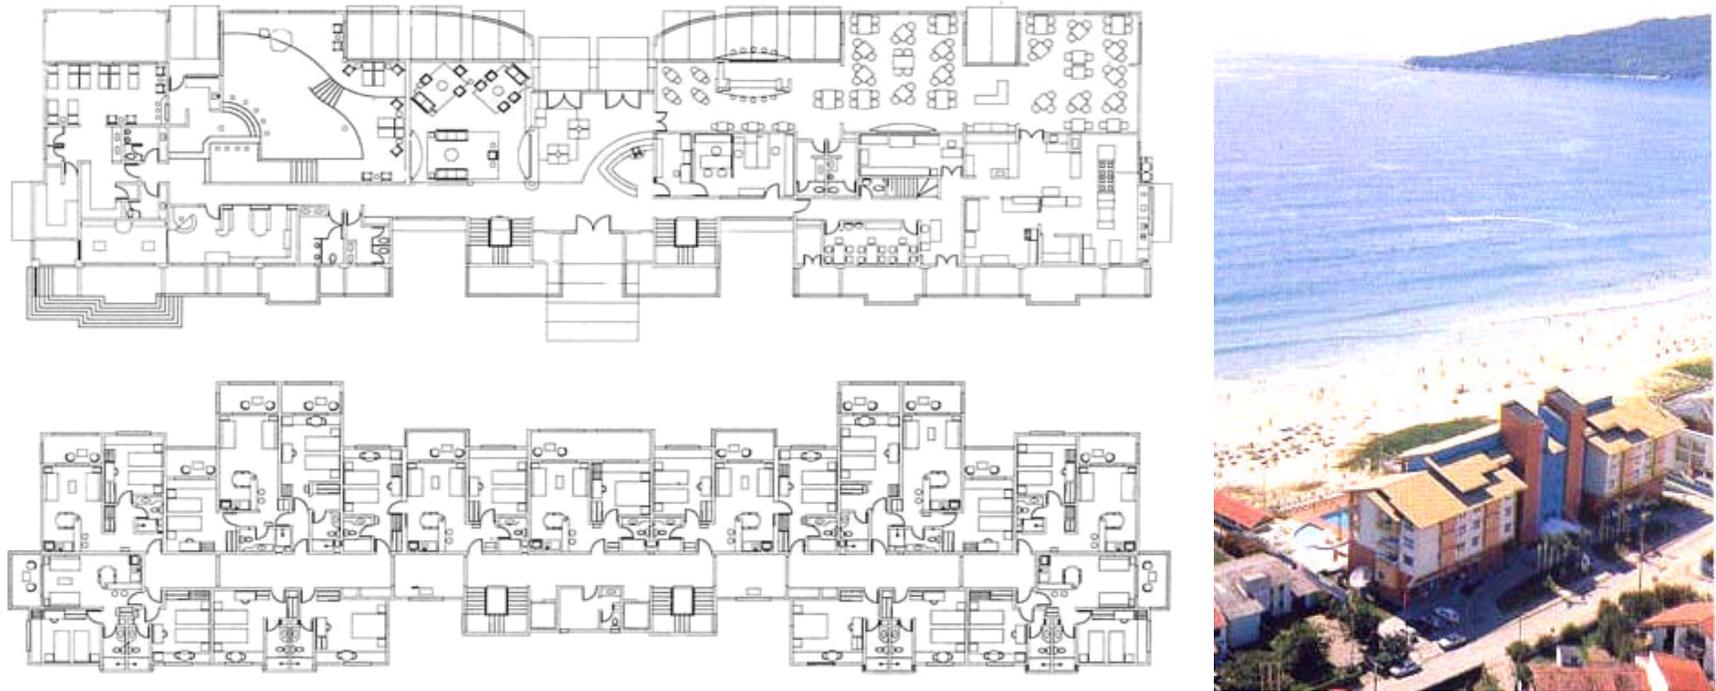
Planta Baja y pavimento tipo y Vista a vuelo de pájaro. (F.: DESENHO ALTERNATIVO
